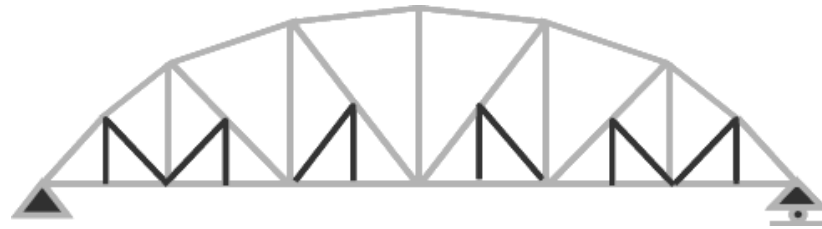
Jembatan Rangka Tipe *Subdivided pratt with substruts or baltimomore truss
